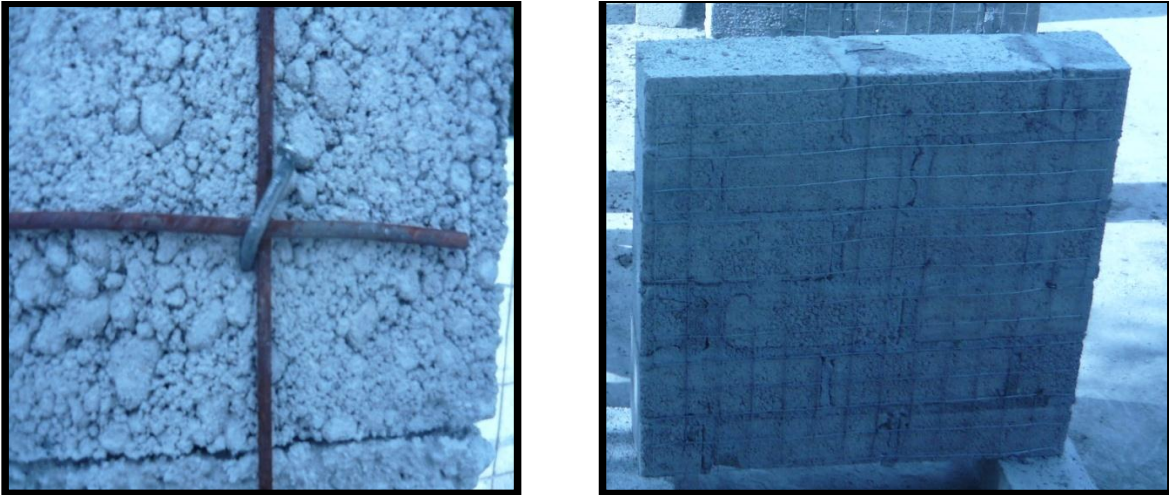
Procedimiento de colocación de anclajes y malla en cada murete.
